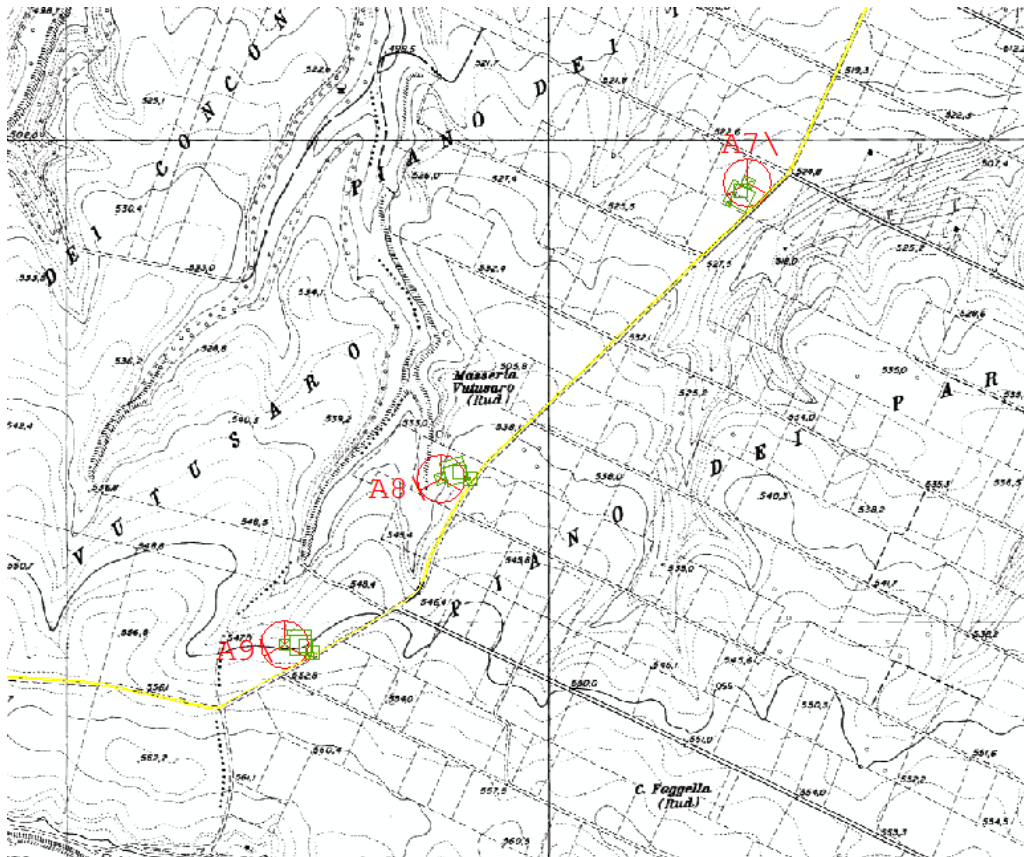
Particolare di Strade e Piazzole interessate dalla costruzione del parco su CTR.
